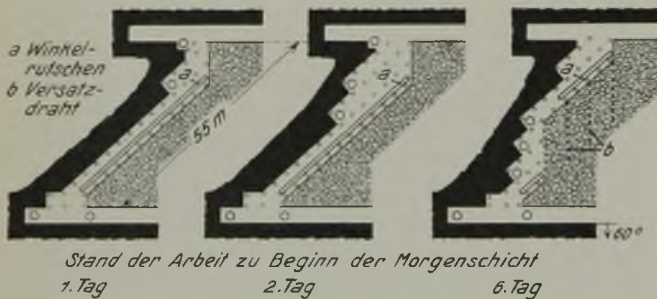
Schrägstoß mit 3 Knäppen und Einbringung des Versatzes in Teilverschlügen.
